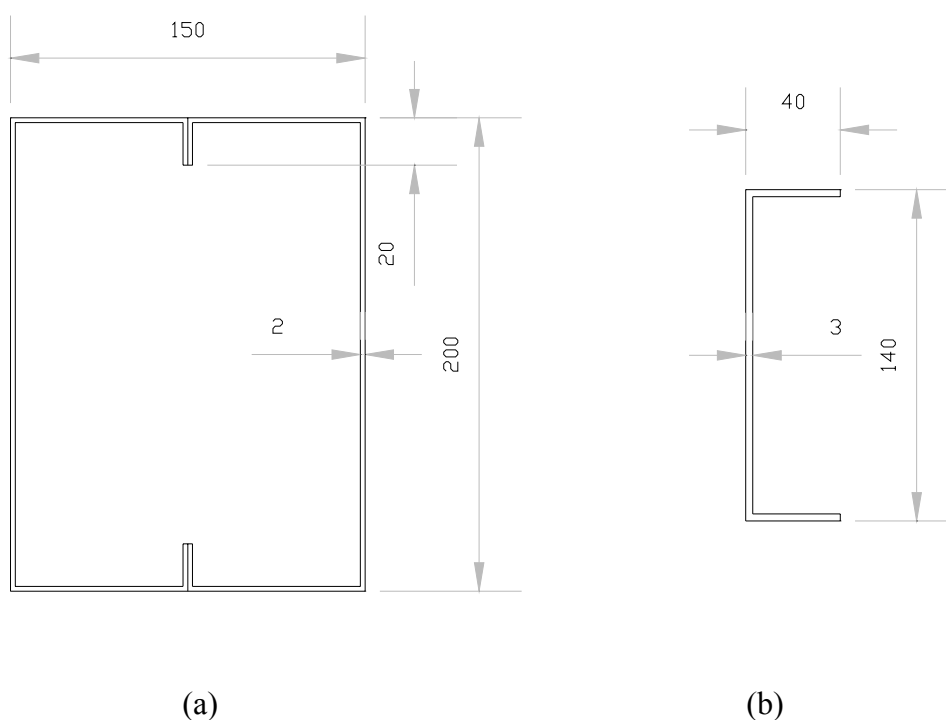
Seção de perfis: (a) viga; (b) contraventamento.
